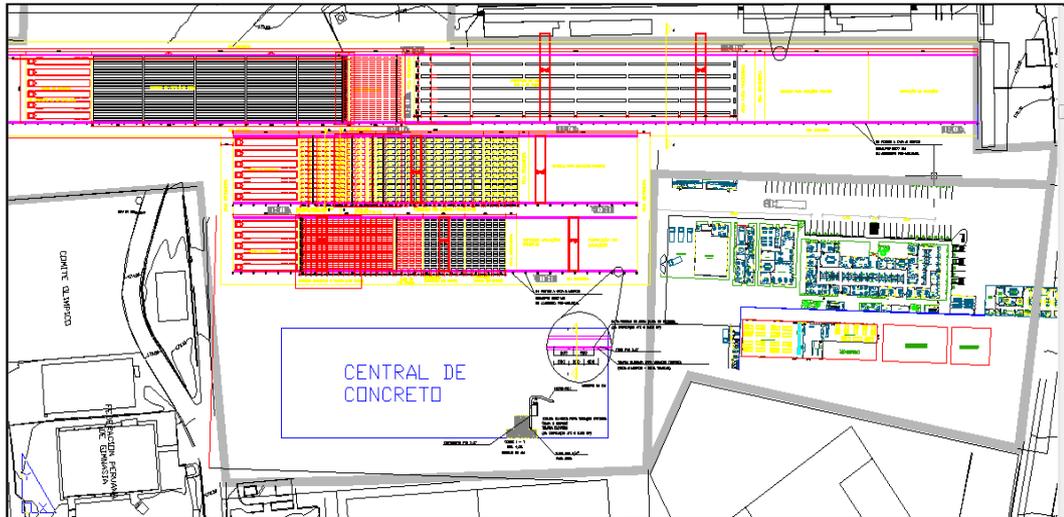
Propuesta inicial 1 de ubicación y distribución de áreas de trabajo en la planta de prefabricados del tramo 1 de la construcción del viaducto del tren eléctrico
